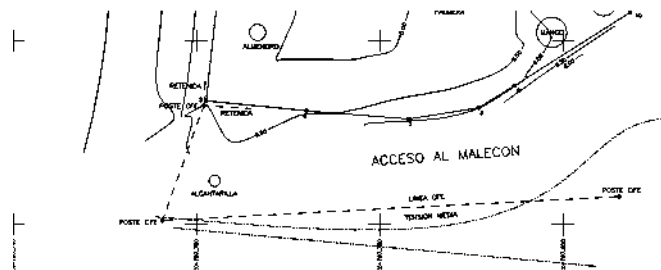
Plano topográfico incluyendo línea de media tensión existente
